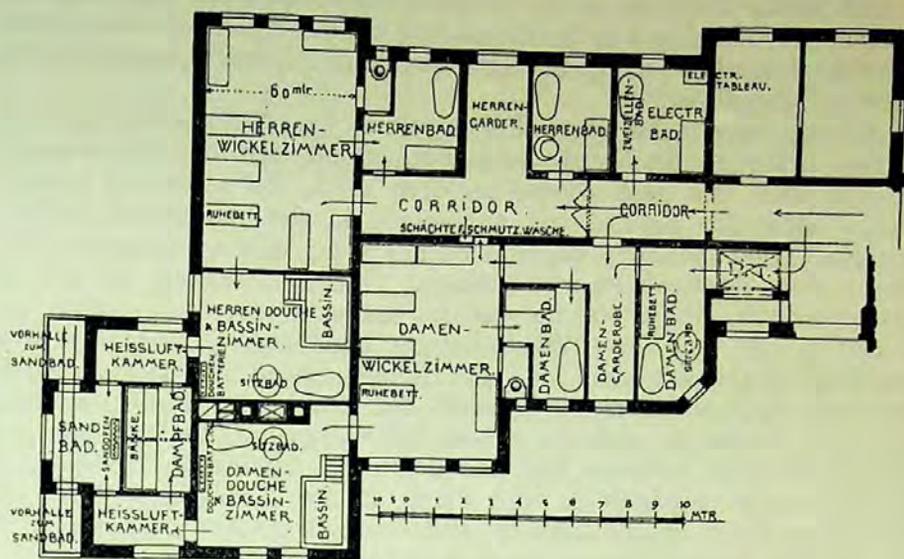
Grundriß der Badeanlage im Neubau der Kuranstalt Neuwittelsbach.
